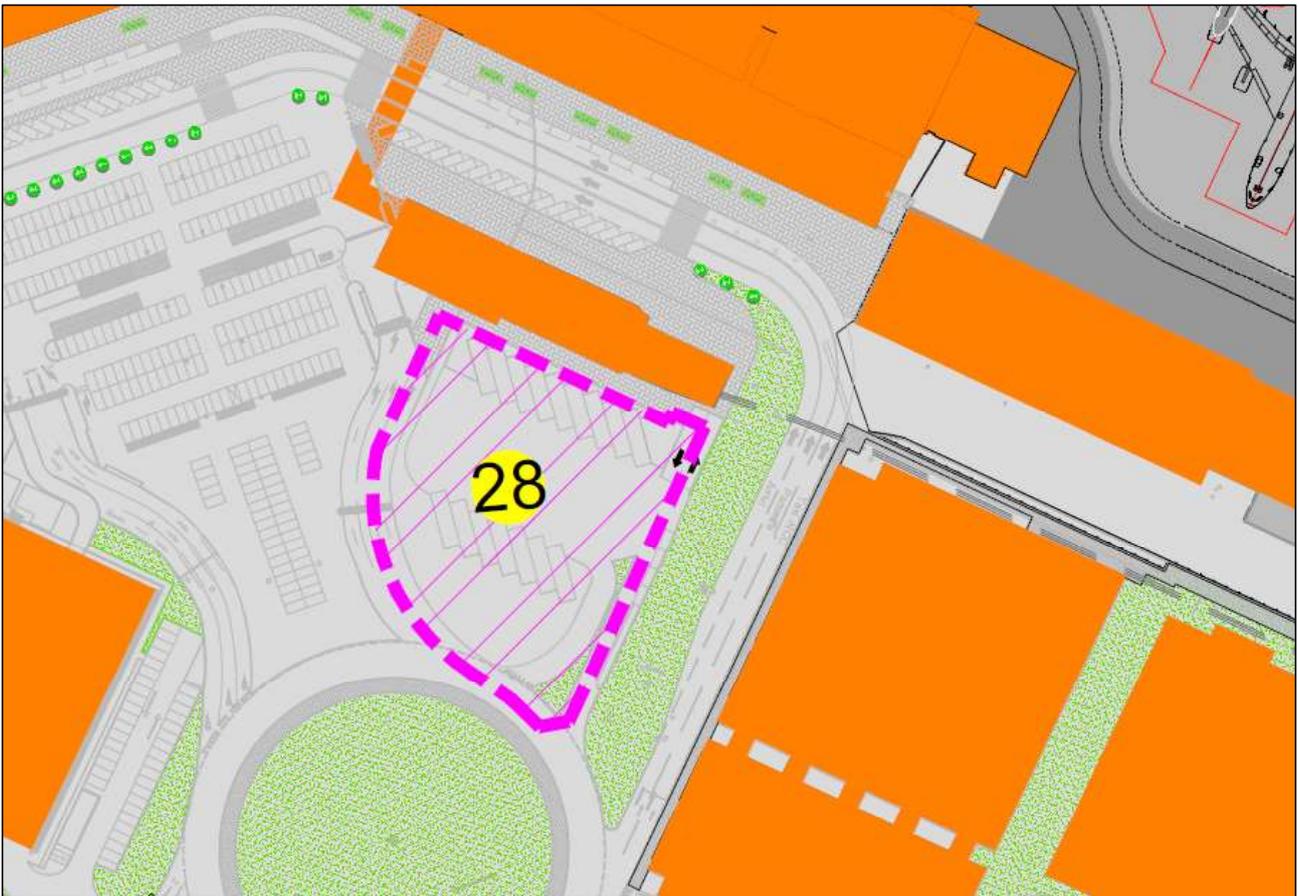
Estratto Master Plan – Nuova Stazione Bus
